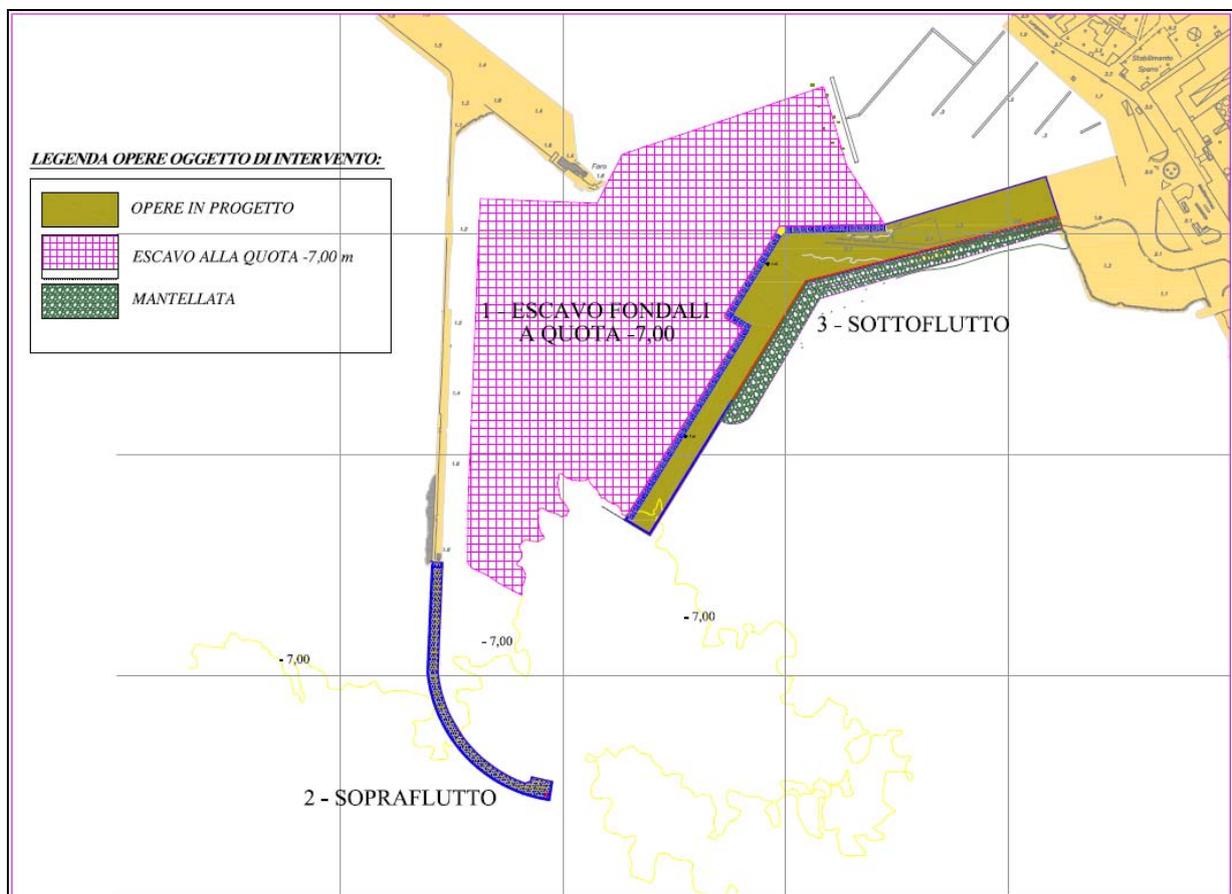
Planimetria specchi acque da sottoporre ad interventi di escavazione.
